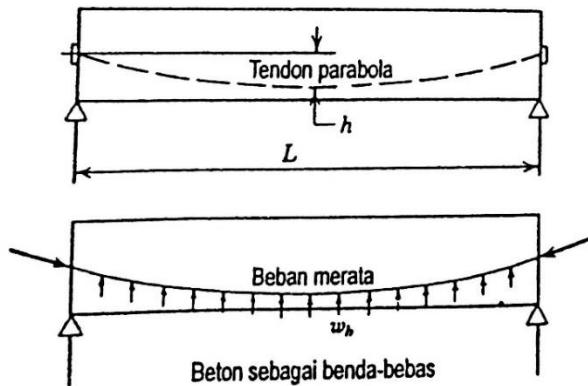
4 Sistem Prategang dengan Baja dan Beton Mutu Tinggi
